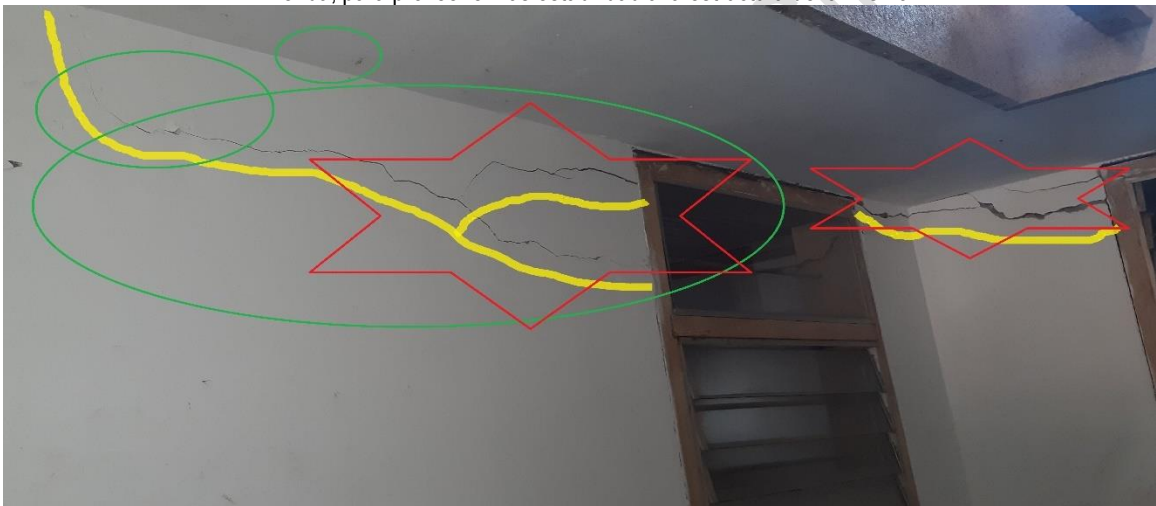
Fisuras, grietas y fractura en sentido horizontal y diagonal, espesor  $\leq 15\text{mm}$  – Presencia de humedad .
